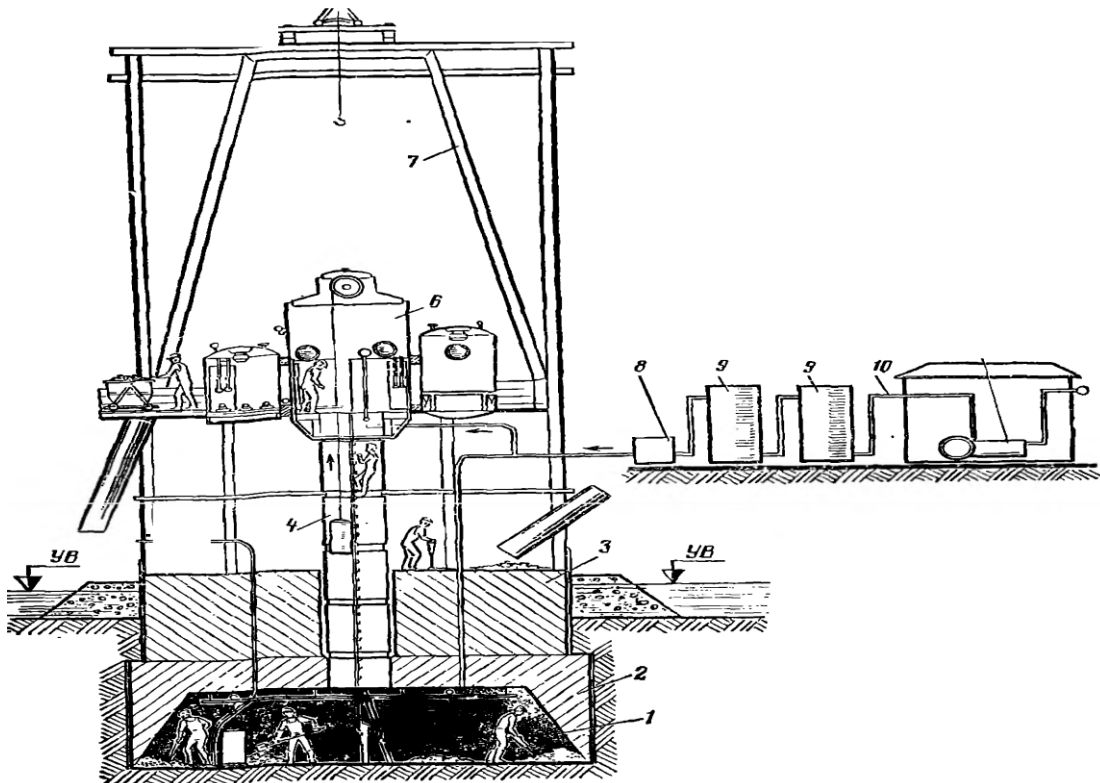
Схема зведення кесонного фундаменту:
